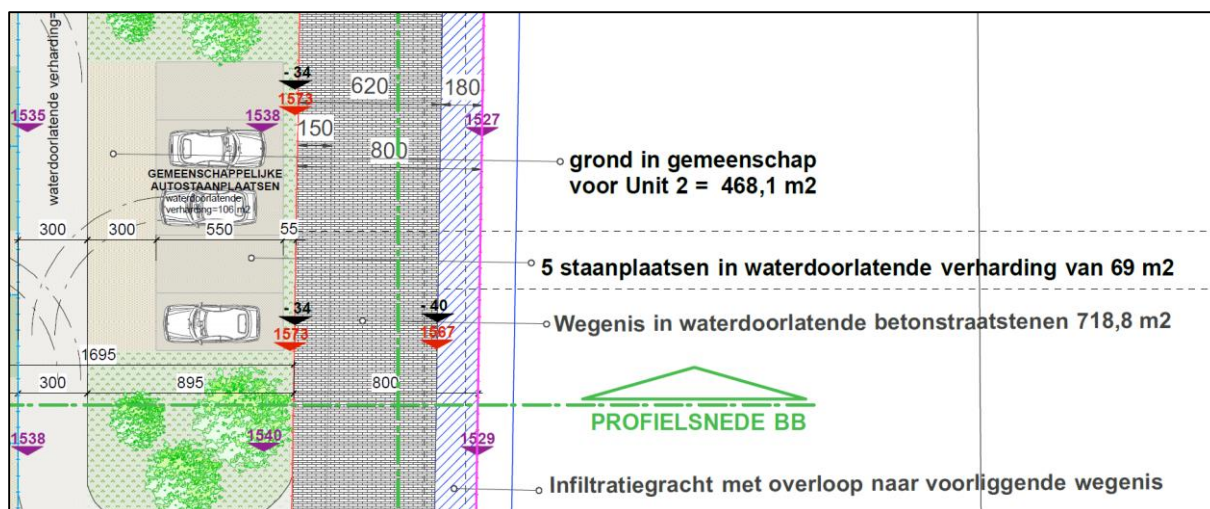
Detail uit het plan van aanleg met betrekking tot de wegenis en de infiltratiegracht ©Tops@home
